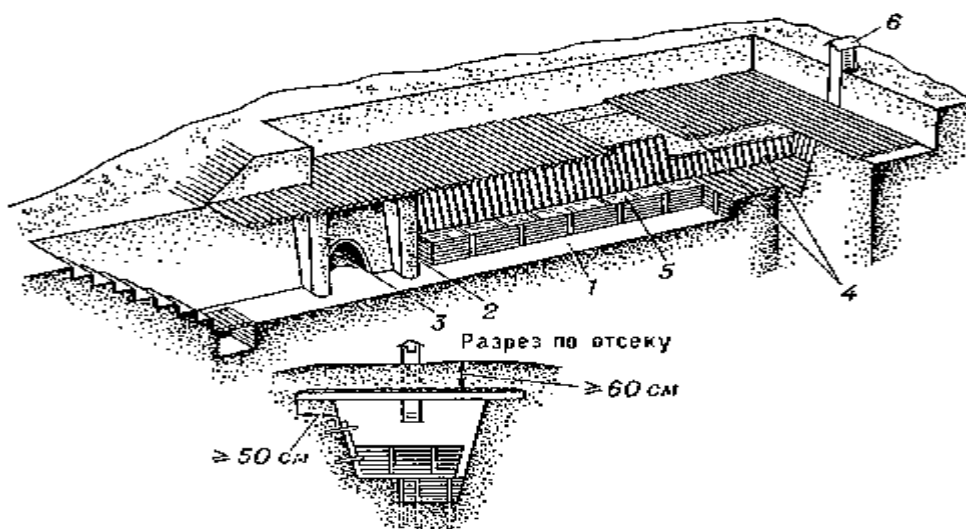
Противорадиационное укрытие из лесоматериалов: 1 — помещение для укрываемых людей; 2 — занавесы на входе; 3 — ниша для выносной тары; 4 — покрытие и одежда стен из подтоварника; 5 — скамьи для укрываемых людей; 6 — вытяжной короб.
